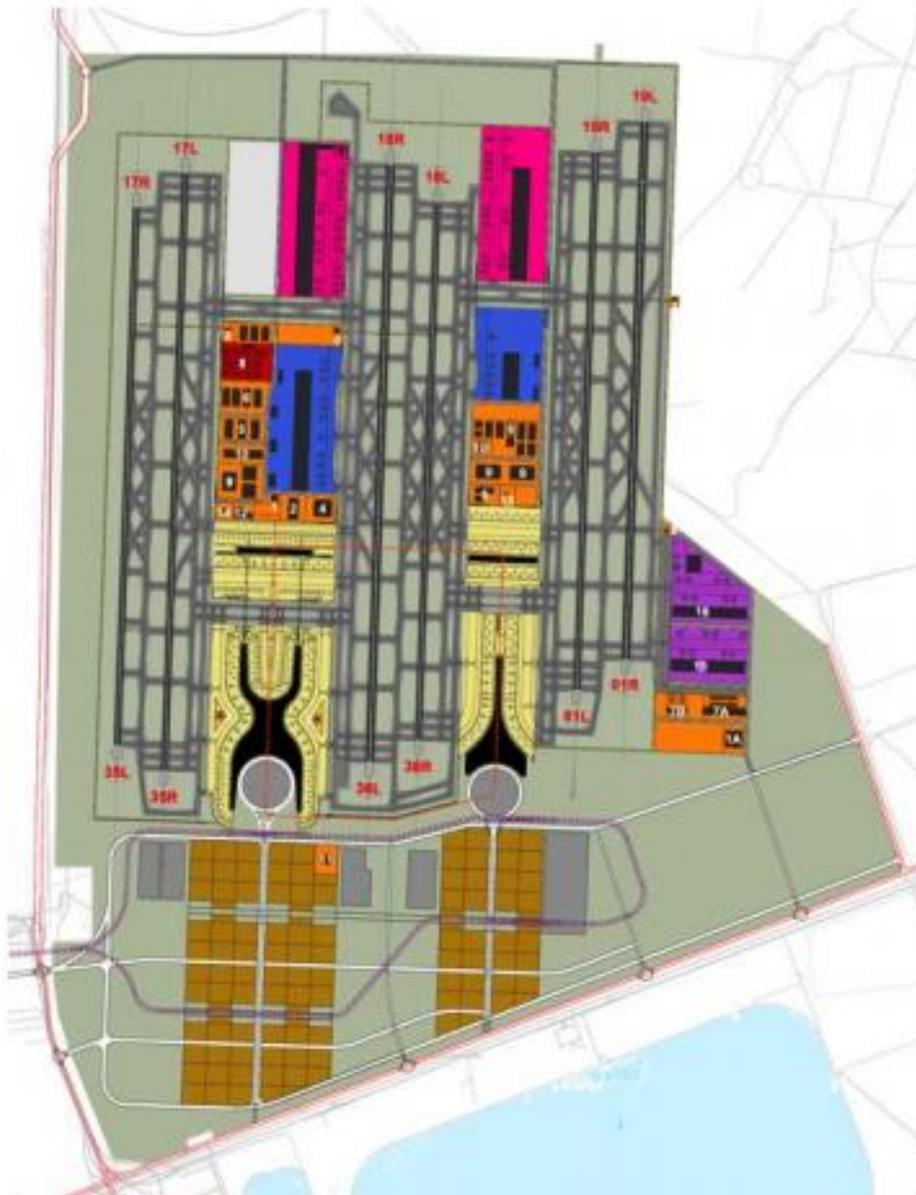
Planta de terminal y pistas del NAICM en su máximo desarrollo
